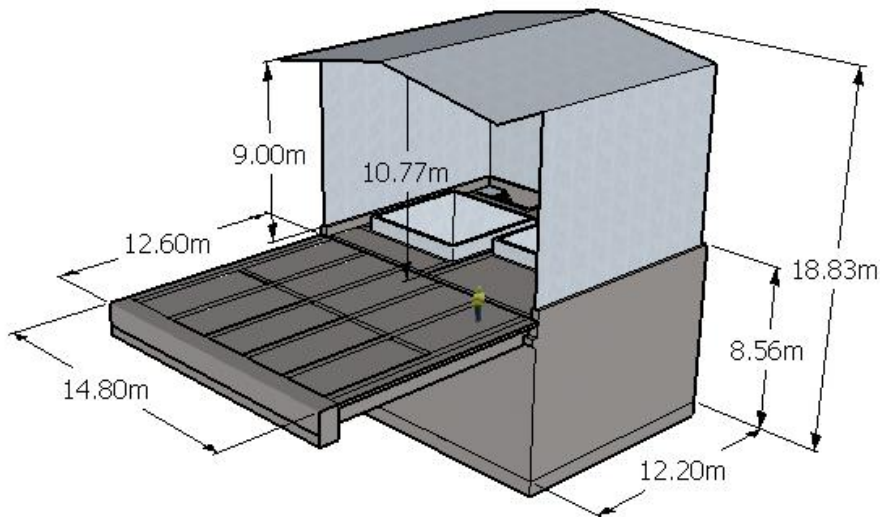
Geometria do Edifício e da Laje de Acesso ("Google Sketchup")
